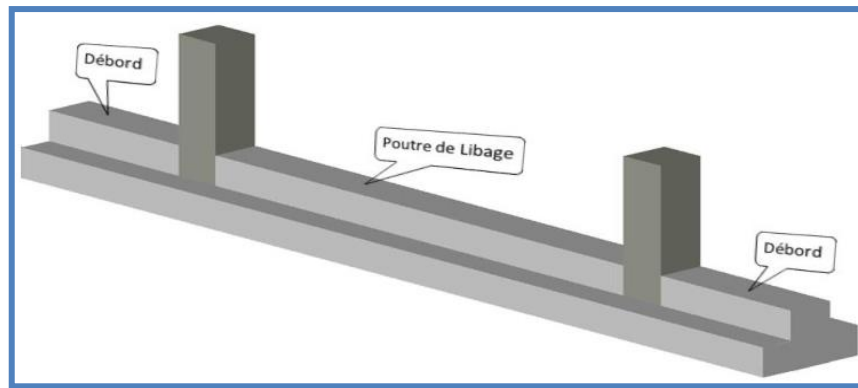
Schéma d'une semelle filante sous poteaux.
